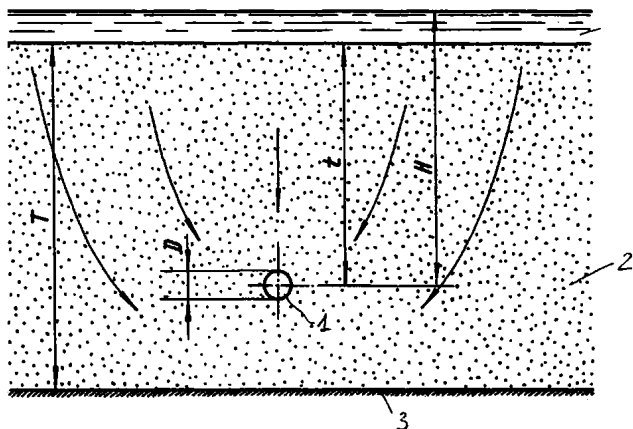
Схема грунтового лотка для испытаний дренажных конструкций по принципу подрусловой дрены
